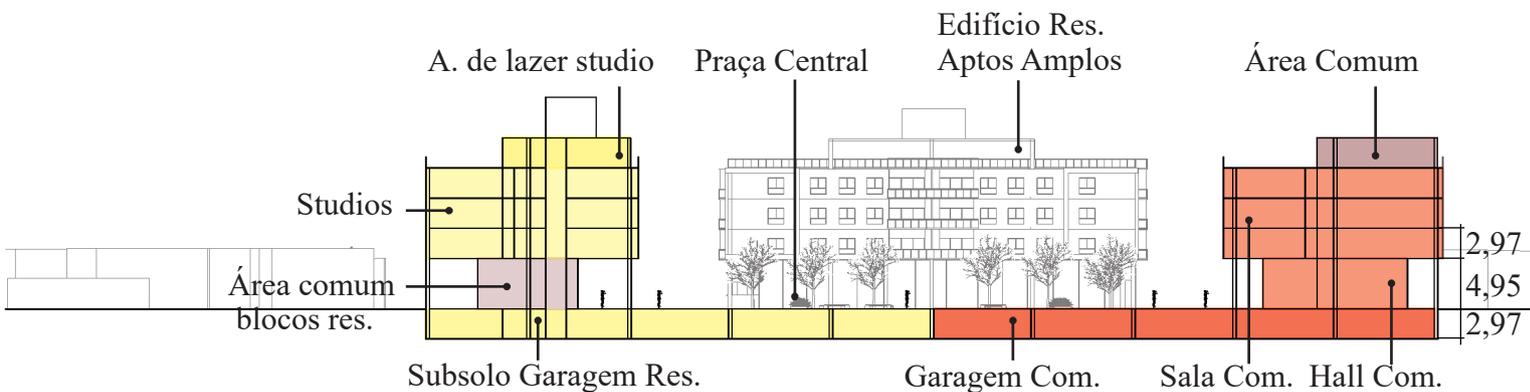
Corte AA' FONTE: Autora. Escala: 1:750
